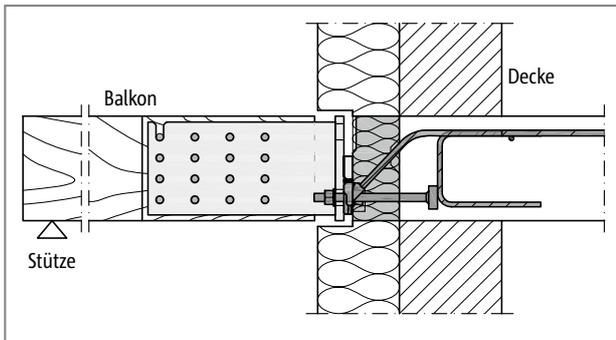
Schöck Isokorb® T Typ SQ mit Stahlschwert: Anschluss an die Stahlbetondecke; Dämmkörper innerhalb der Außendämmung
